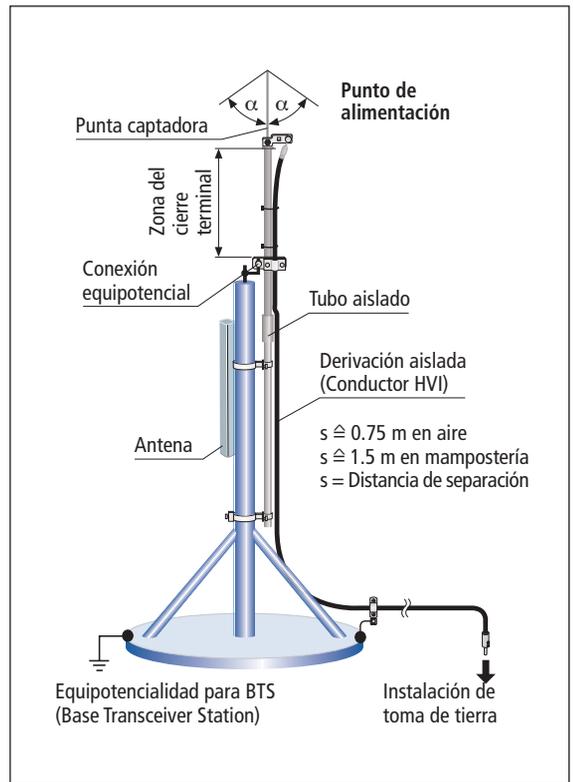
Instalación de sistema captador aislado de protección contra rayos en antena de telefonía móvil.
